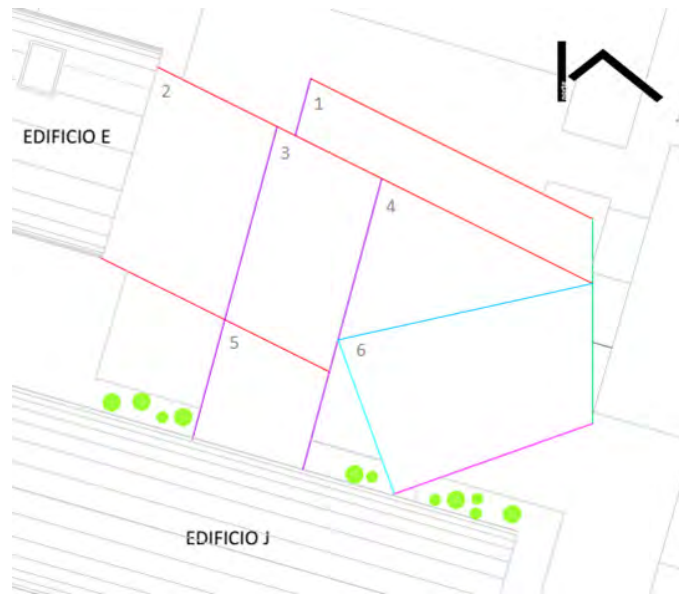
Líneas de proyección vistas en planta para el segundo edificio.
